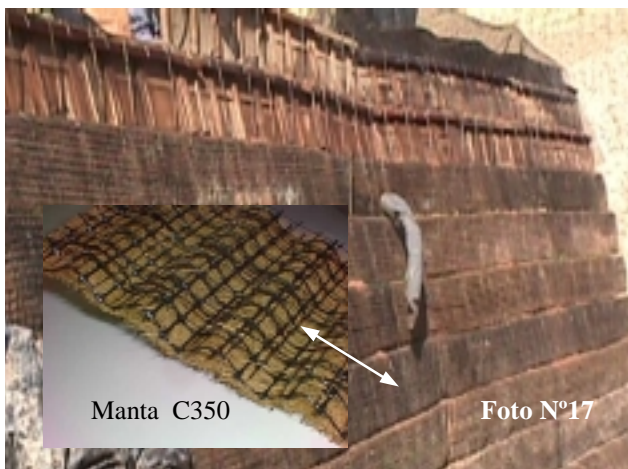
vista del muro en progreso donde se aprecia la salida de uno de los drenes .
